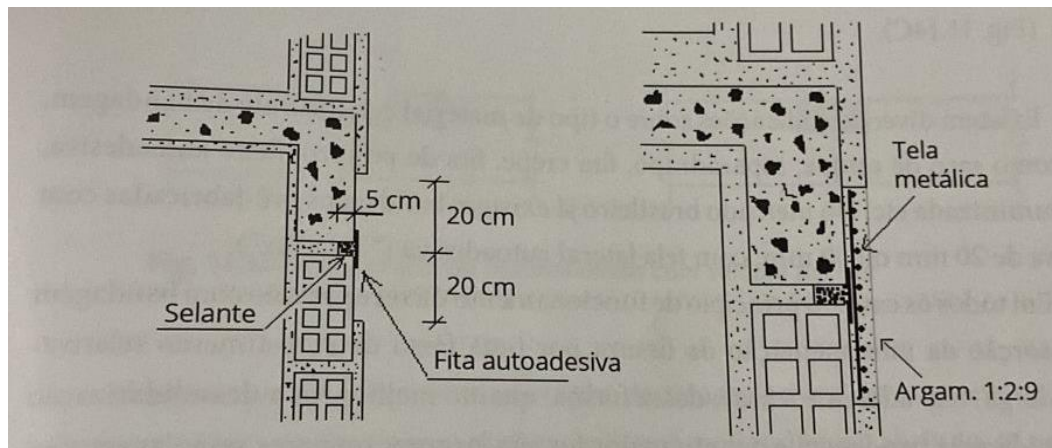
Recuperação de descolamento entre alvenaria e pilar com tela metálica.
